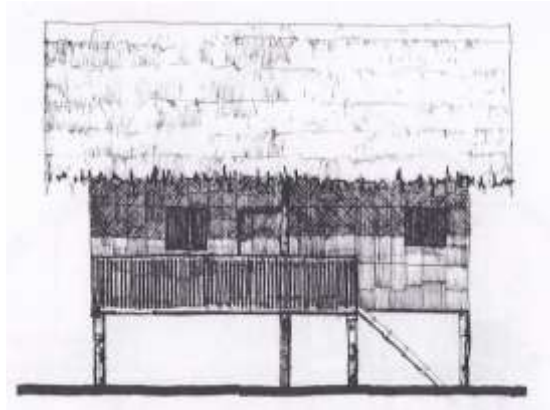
Vivienda Tradicional Manabita. Planta elevada del suelo mediante pilotes de madera. Estructura vertical de madera y horizontal de caña, cerramientos de "quincha" de caña picada y barro y cubierta vegetal.
